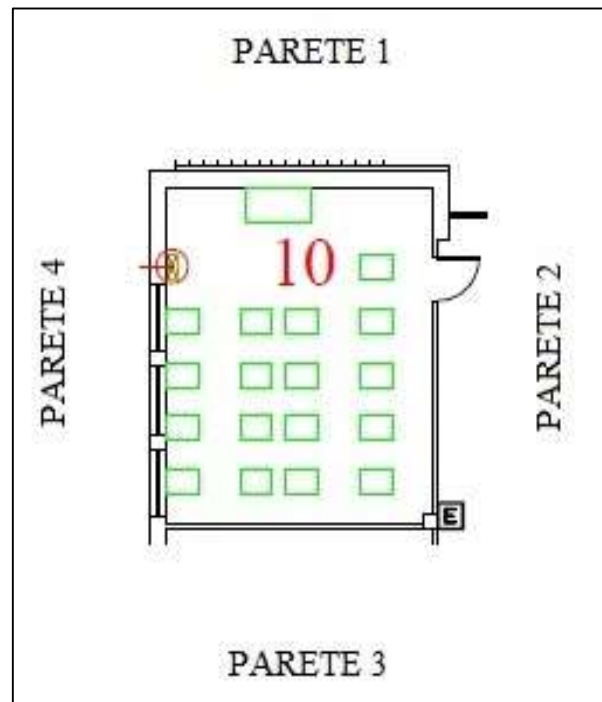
Planimetria dell'Aula 10 (5°B) oggetto di misurazioni
